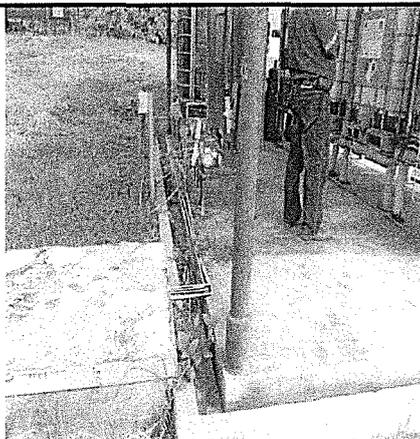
E349083 N9681478 (PSAD 56) / Locación del pozo Tambo 01
